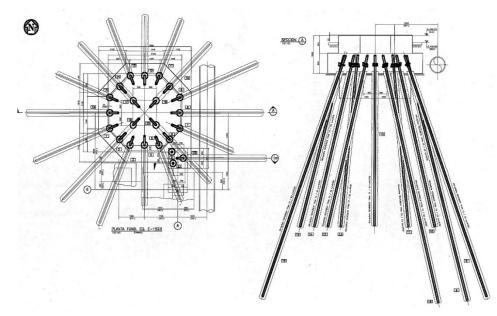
Planta y corte de una de las fundaciones ejecutadas con micropilotes inyectados
